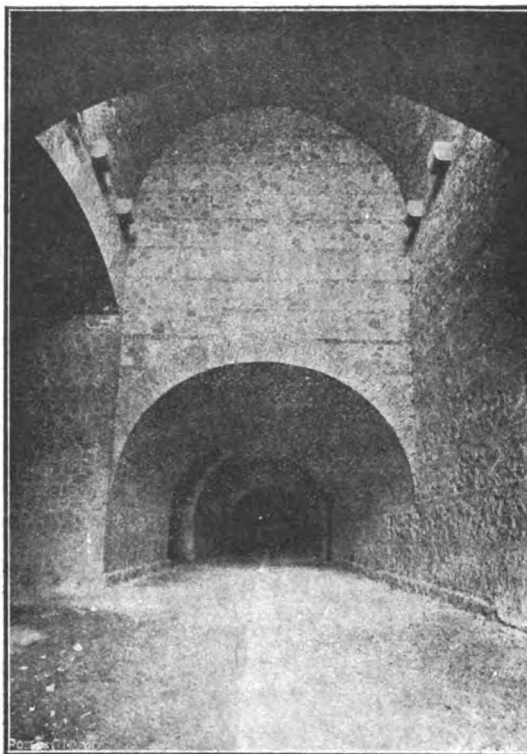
Tratto di galleria con l'imposta della calotta sopralzata.
